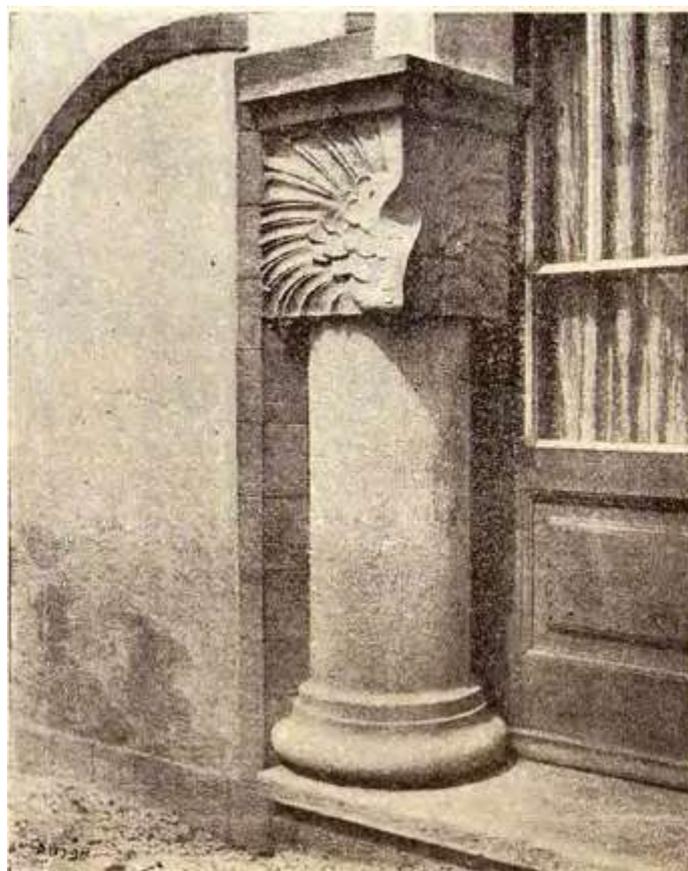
Casal de São Roque, detalhe de cantaria da moldura da uma porta. (A Construção Moderna, 1904a).
